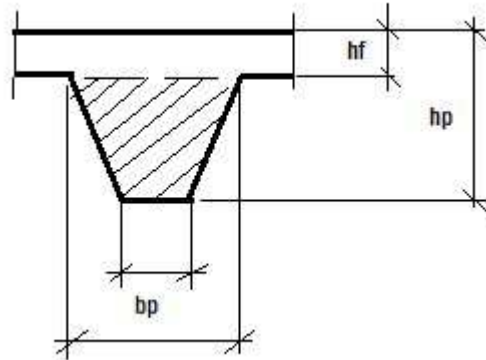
Схема определения расчетных нагрузок от ребра
